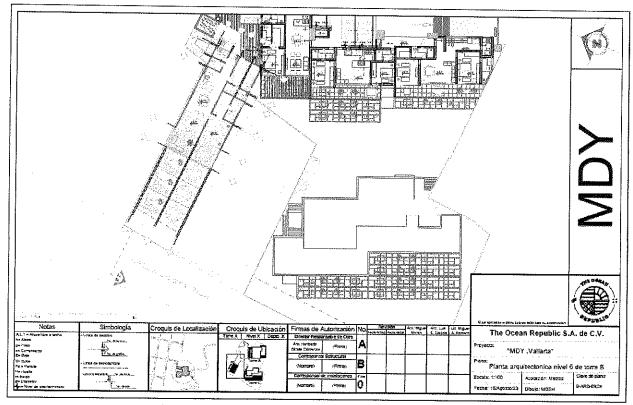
Planta arquitectónica nivel 6 de torre B
